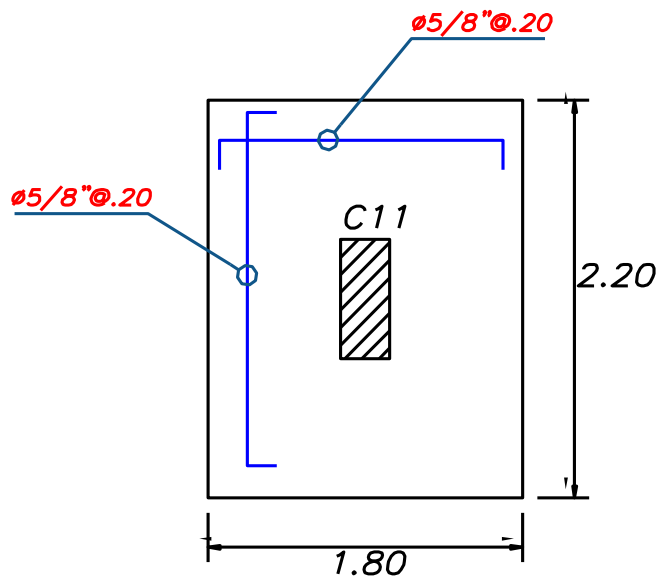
Sección final con Acero de Refuerzo en la Zapata Z-11
